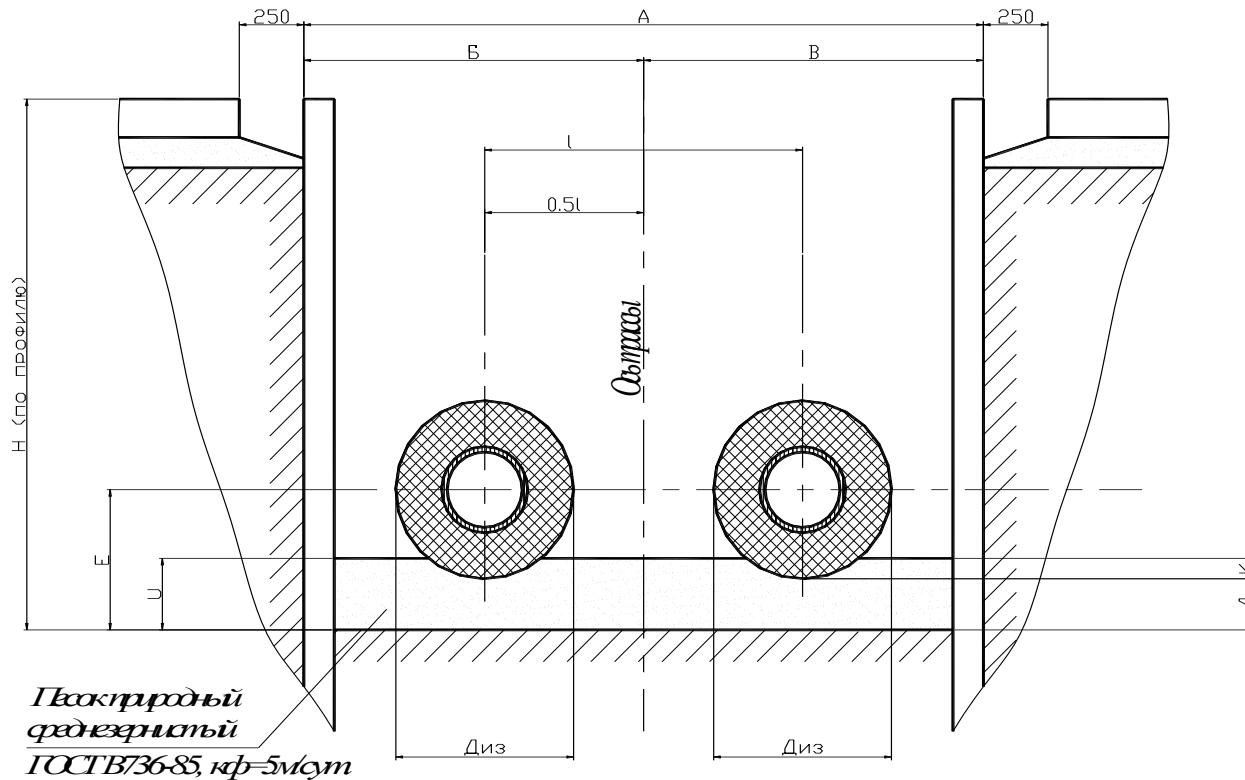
Бесканальная прокладка теплопроводов в ППМ изоляции без устройства продольного дренажа.
